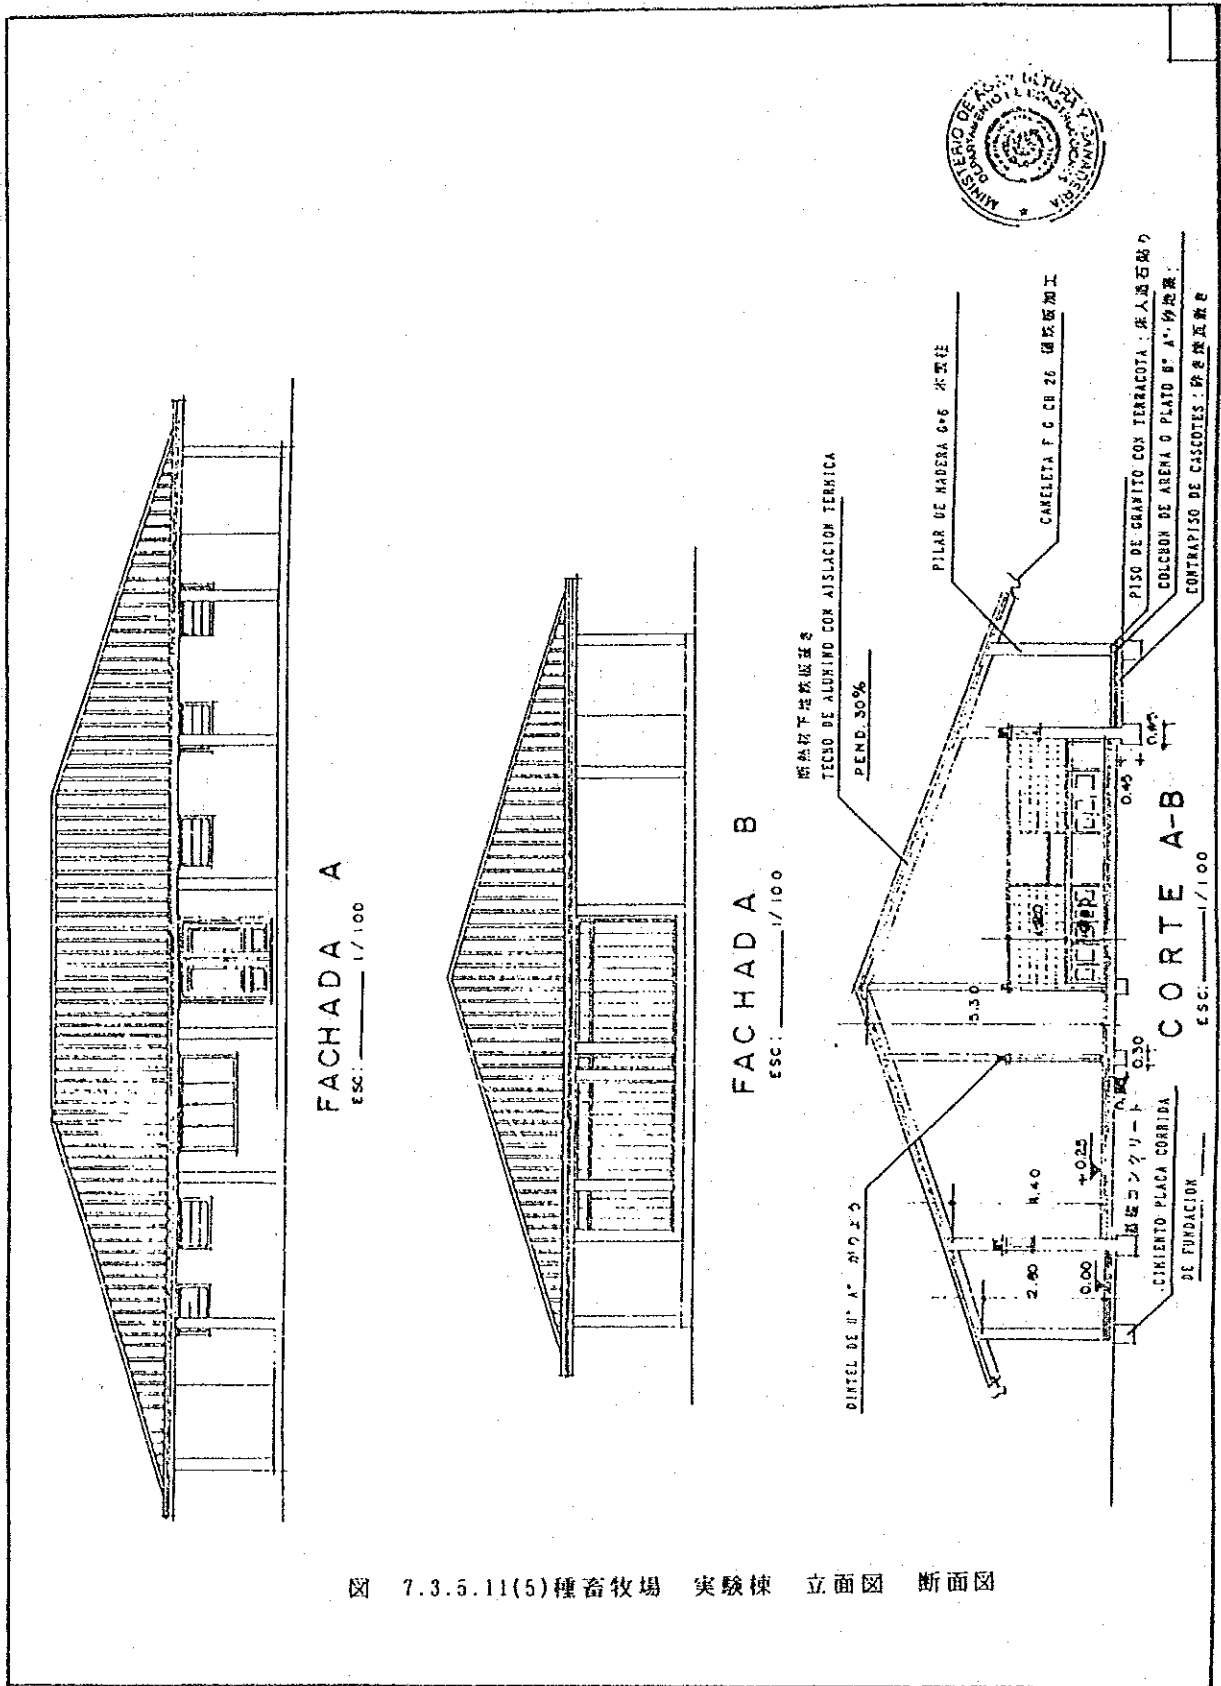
(5)種畜牧場 実験棟 立面図 断面図
